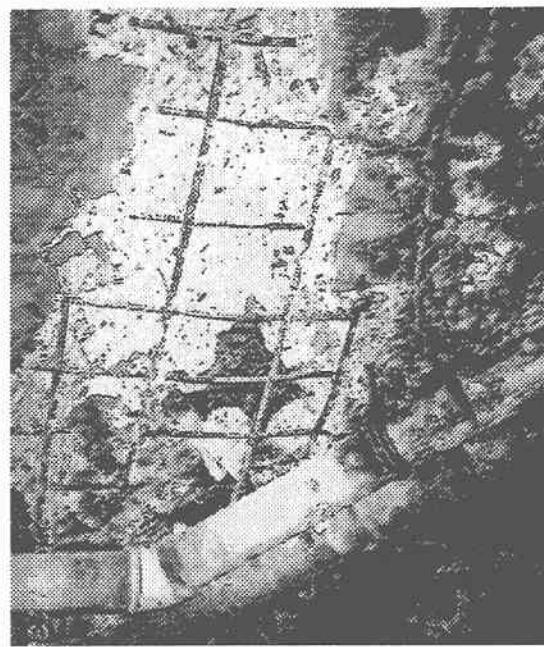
スラブコンクリート剥落、鉄筋露出
